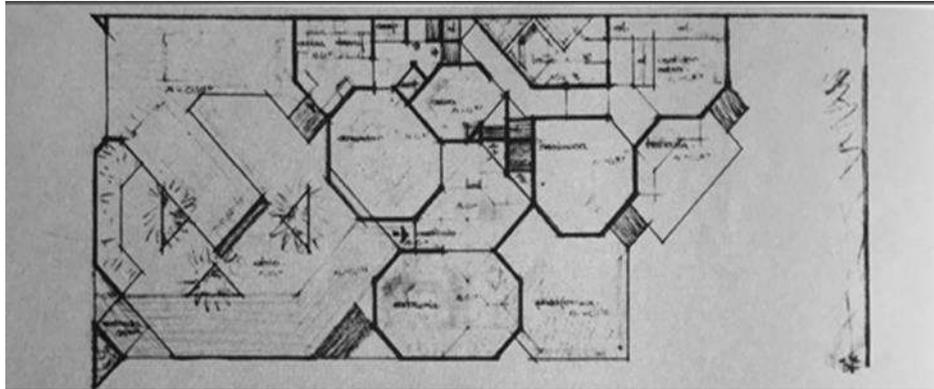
Planta de la vivienda Díaz Barreiro, 1969.
